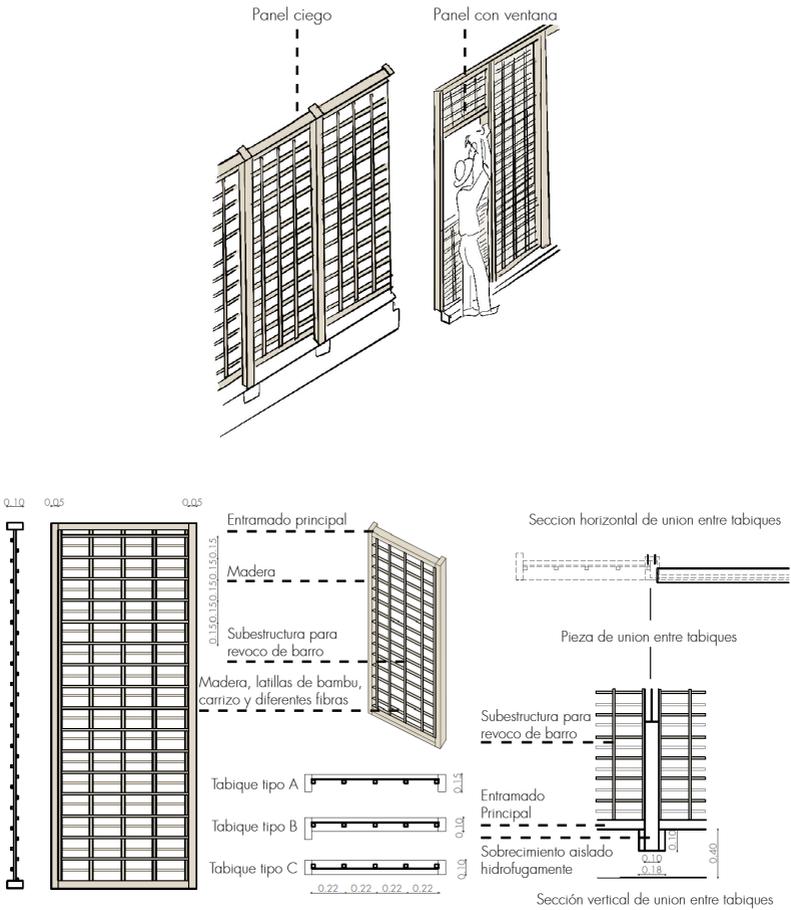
| Sistema reinterpretado de entramados de bahareque. | Fuente: Autoría Propia (2024).
